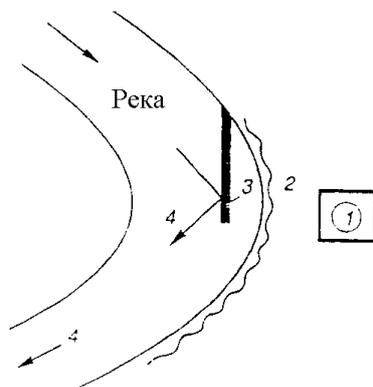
Струенаправляющая стенка в русле реки: 1 – здание; 2 – размываемый берег; 3 – струенаправляющая стенка; 4 – течение реки
